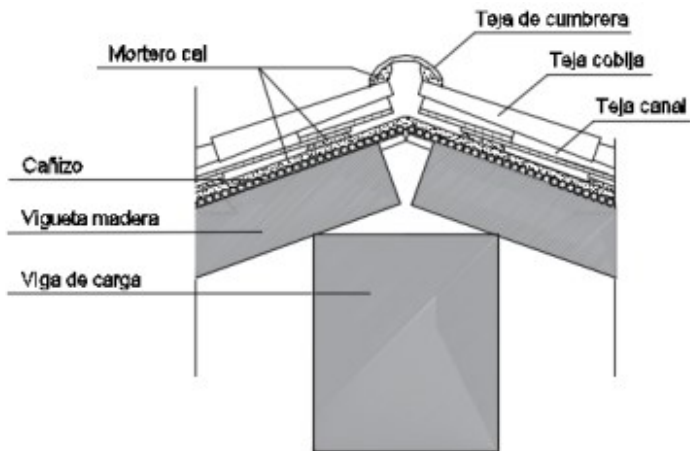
Detalle Cumbra existente. 2016. Fuentes propias
